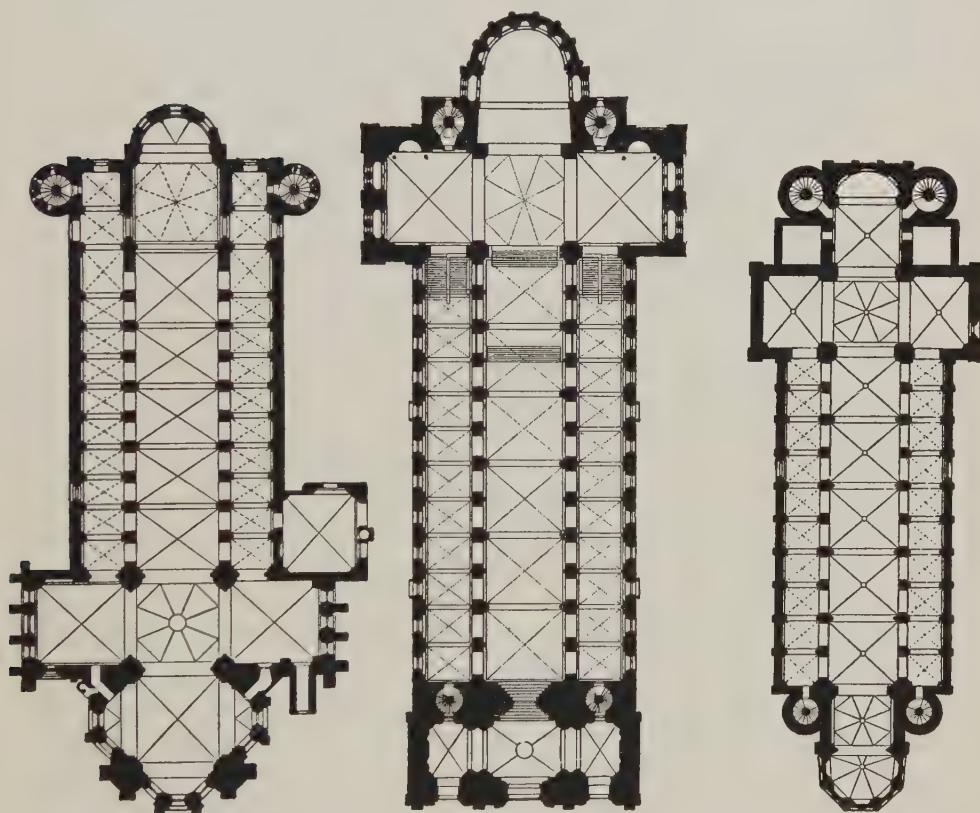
Mainz — Speyer — Worms, Grundrisse. Nach Dehio und v. Bezold
